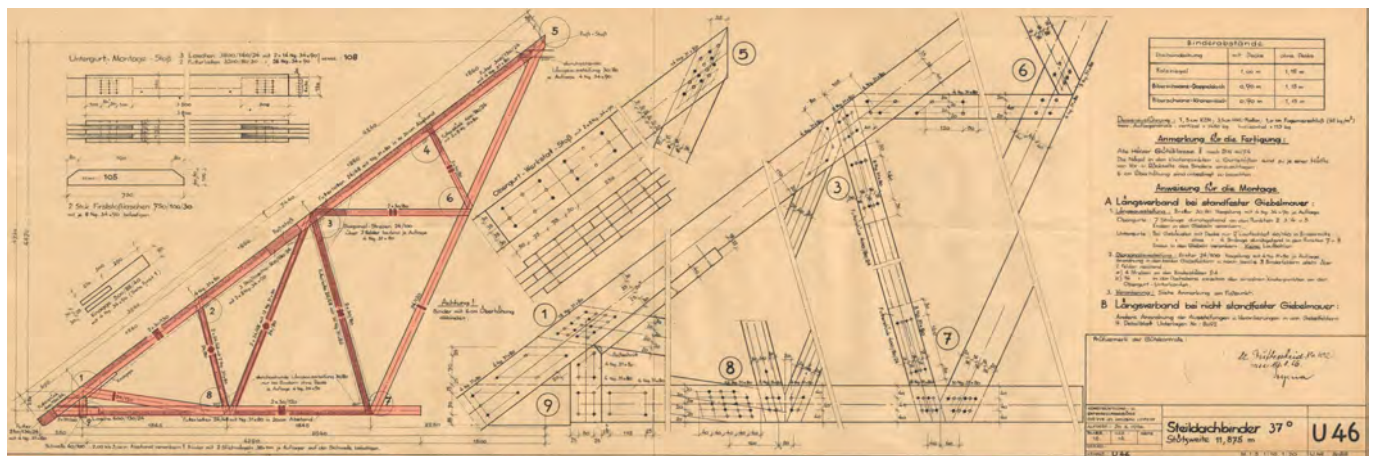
Steildachbinder Typ U46, 37° Dachneigung, Stützweite 11,875 m, Bj. 1956, Konstruktions- und Entwicklungsbüro der VVB IZL Holzbau Leipzig (Quelle: Archiv Ingenieurbüro Bauen, Weimar)
